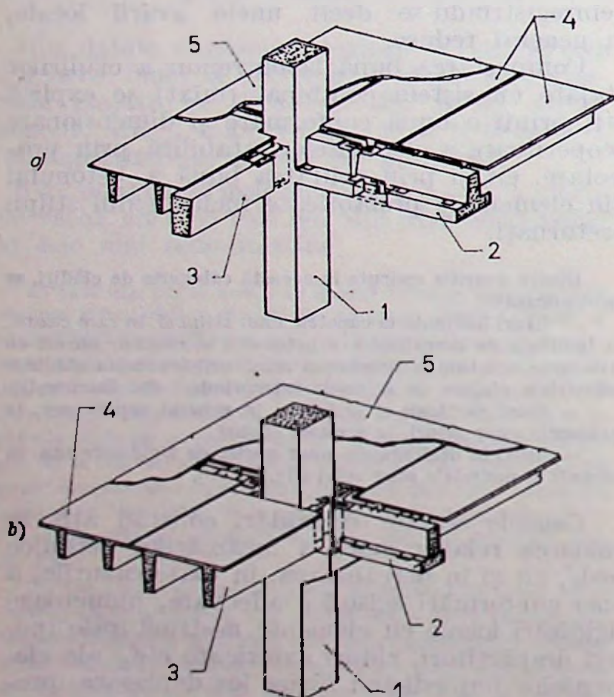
Schema de alcătuire a structurilor integral prefabricate de beton armat pentru clădiri industriale etajate: a — Varianta 1; b — varianta 2; 1 — stîlp prefabricat; 2 — grindă prefabricată transversală; 3 — grindă prefabricată longitudinală; 4 — element prefabricat de planșeu; 5 — suprabetonare.
